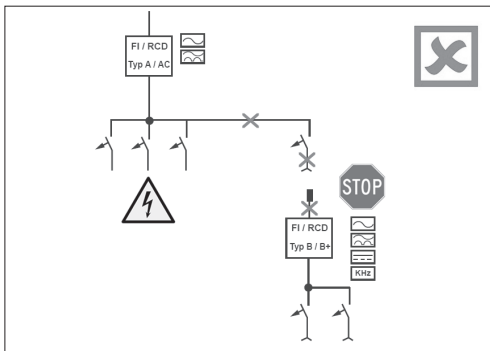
Installazione elettrica difettosa (impianto di distribuzione domestico)
